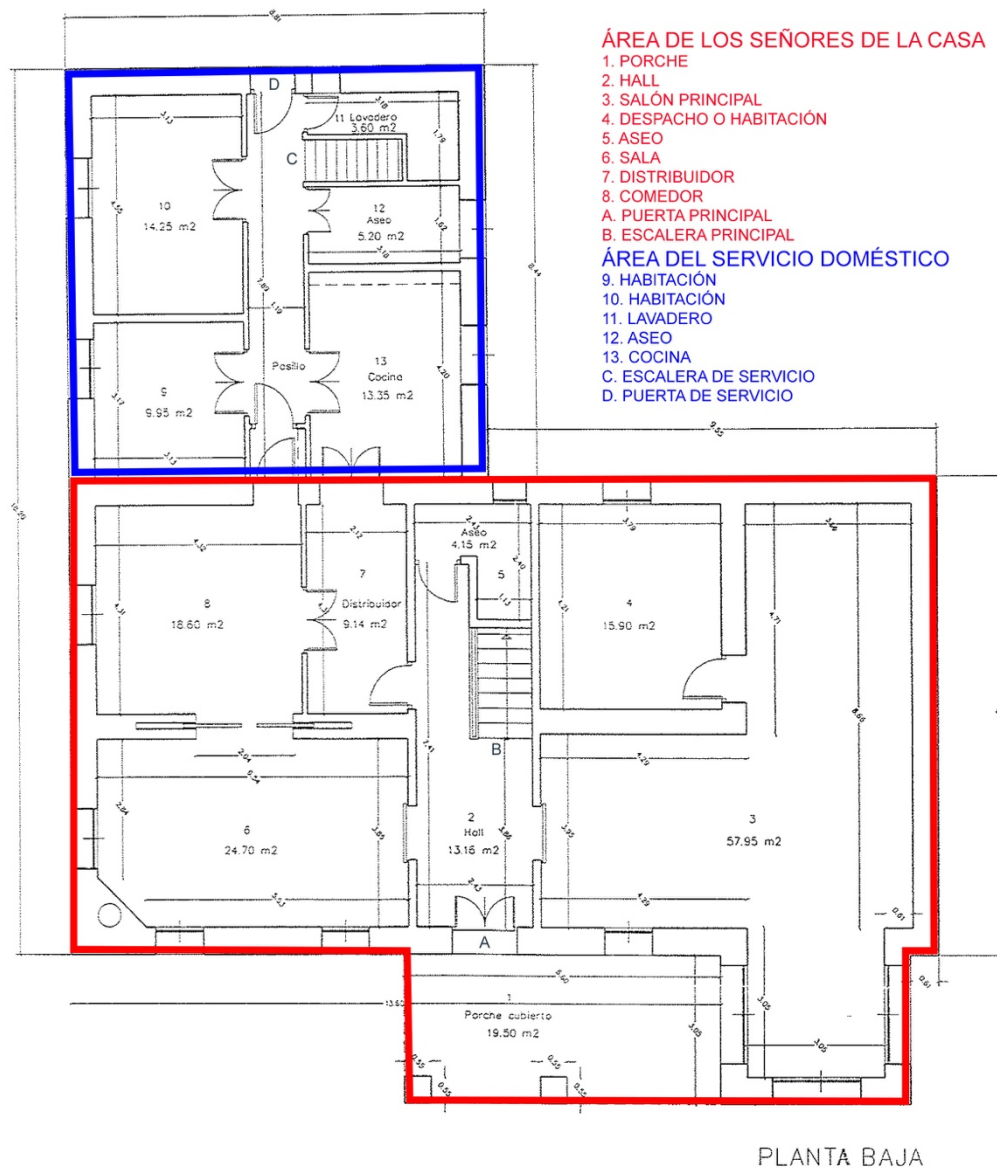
Plano de la planta baja de la casa principal de la Finca La Parra. Fuente: Elaboración propia en base a plano AENA.
